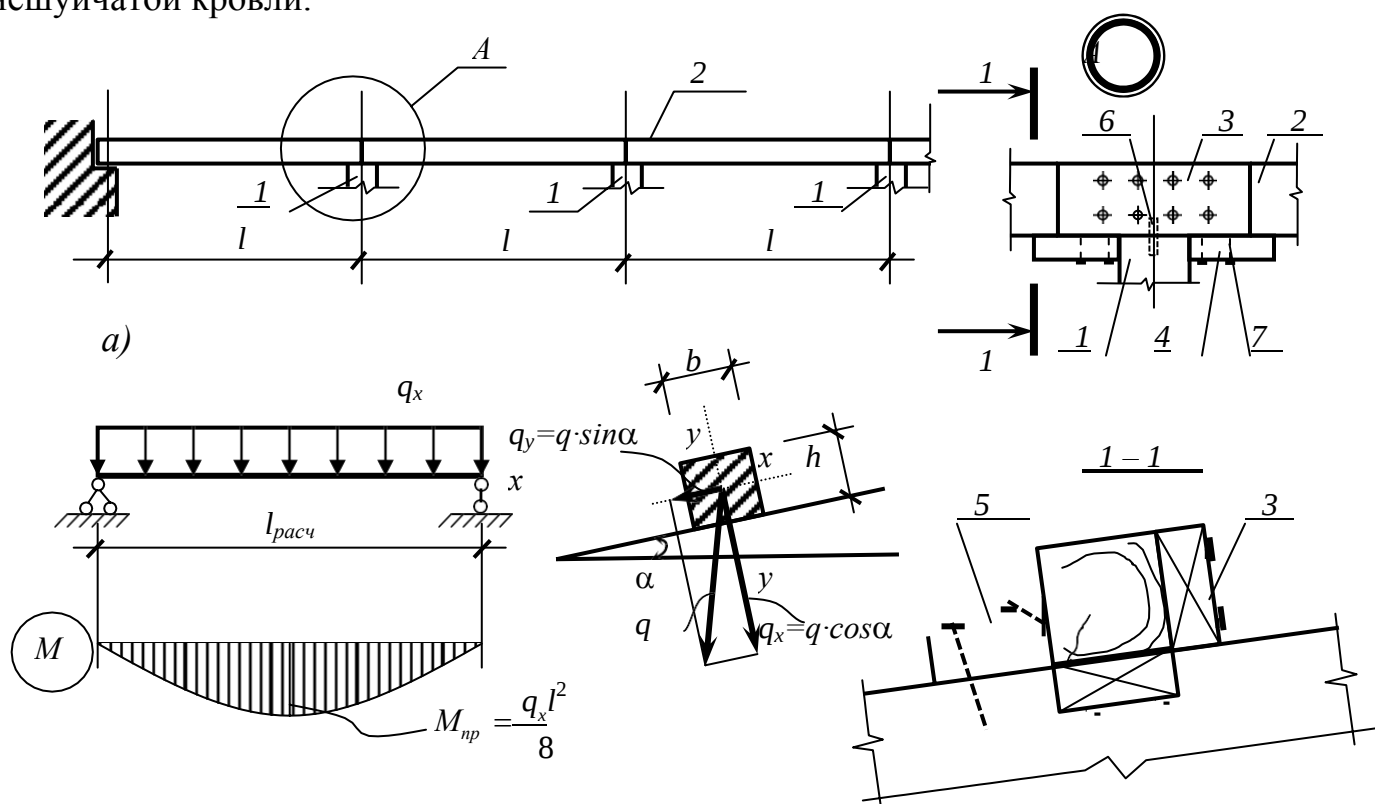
Схема разрезного прогона: а – расчетная схема. 1 – несущая конструкция; 2 – прогон; 3 – накладка на стыке прогонов; 4 – упорные кобылки из досок; 5 – бобышка; 6 – стальной стержень; 7 – гвозди
